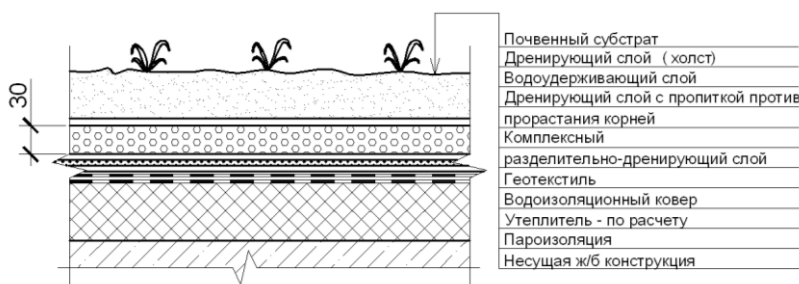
Зеленая кровля по грунтовому слою по жесткому плитному утеплителю
